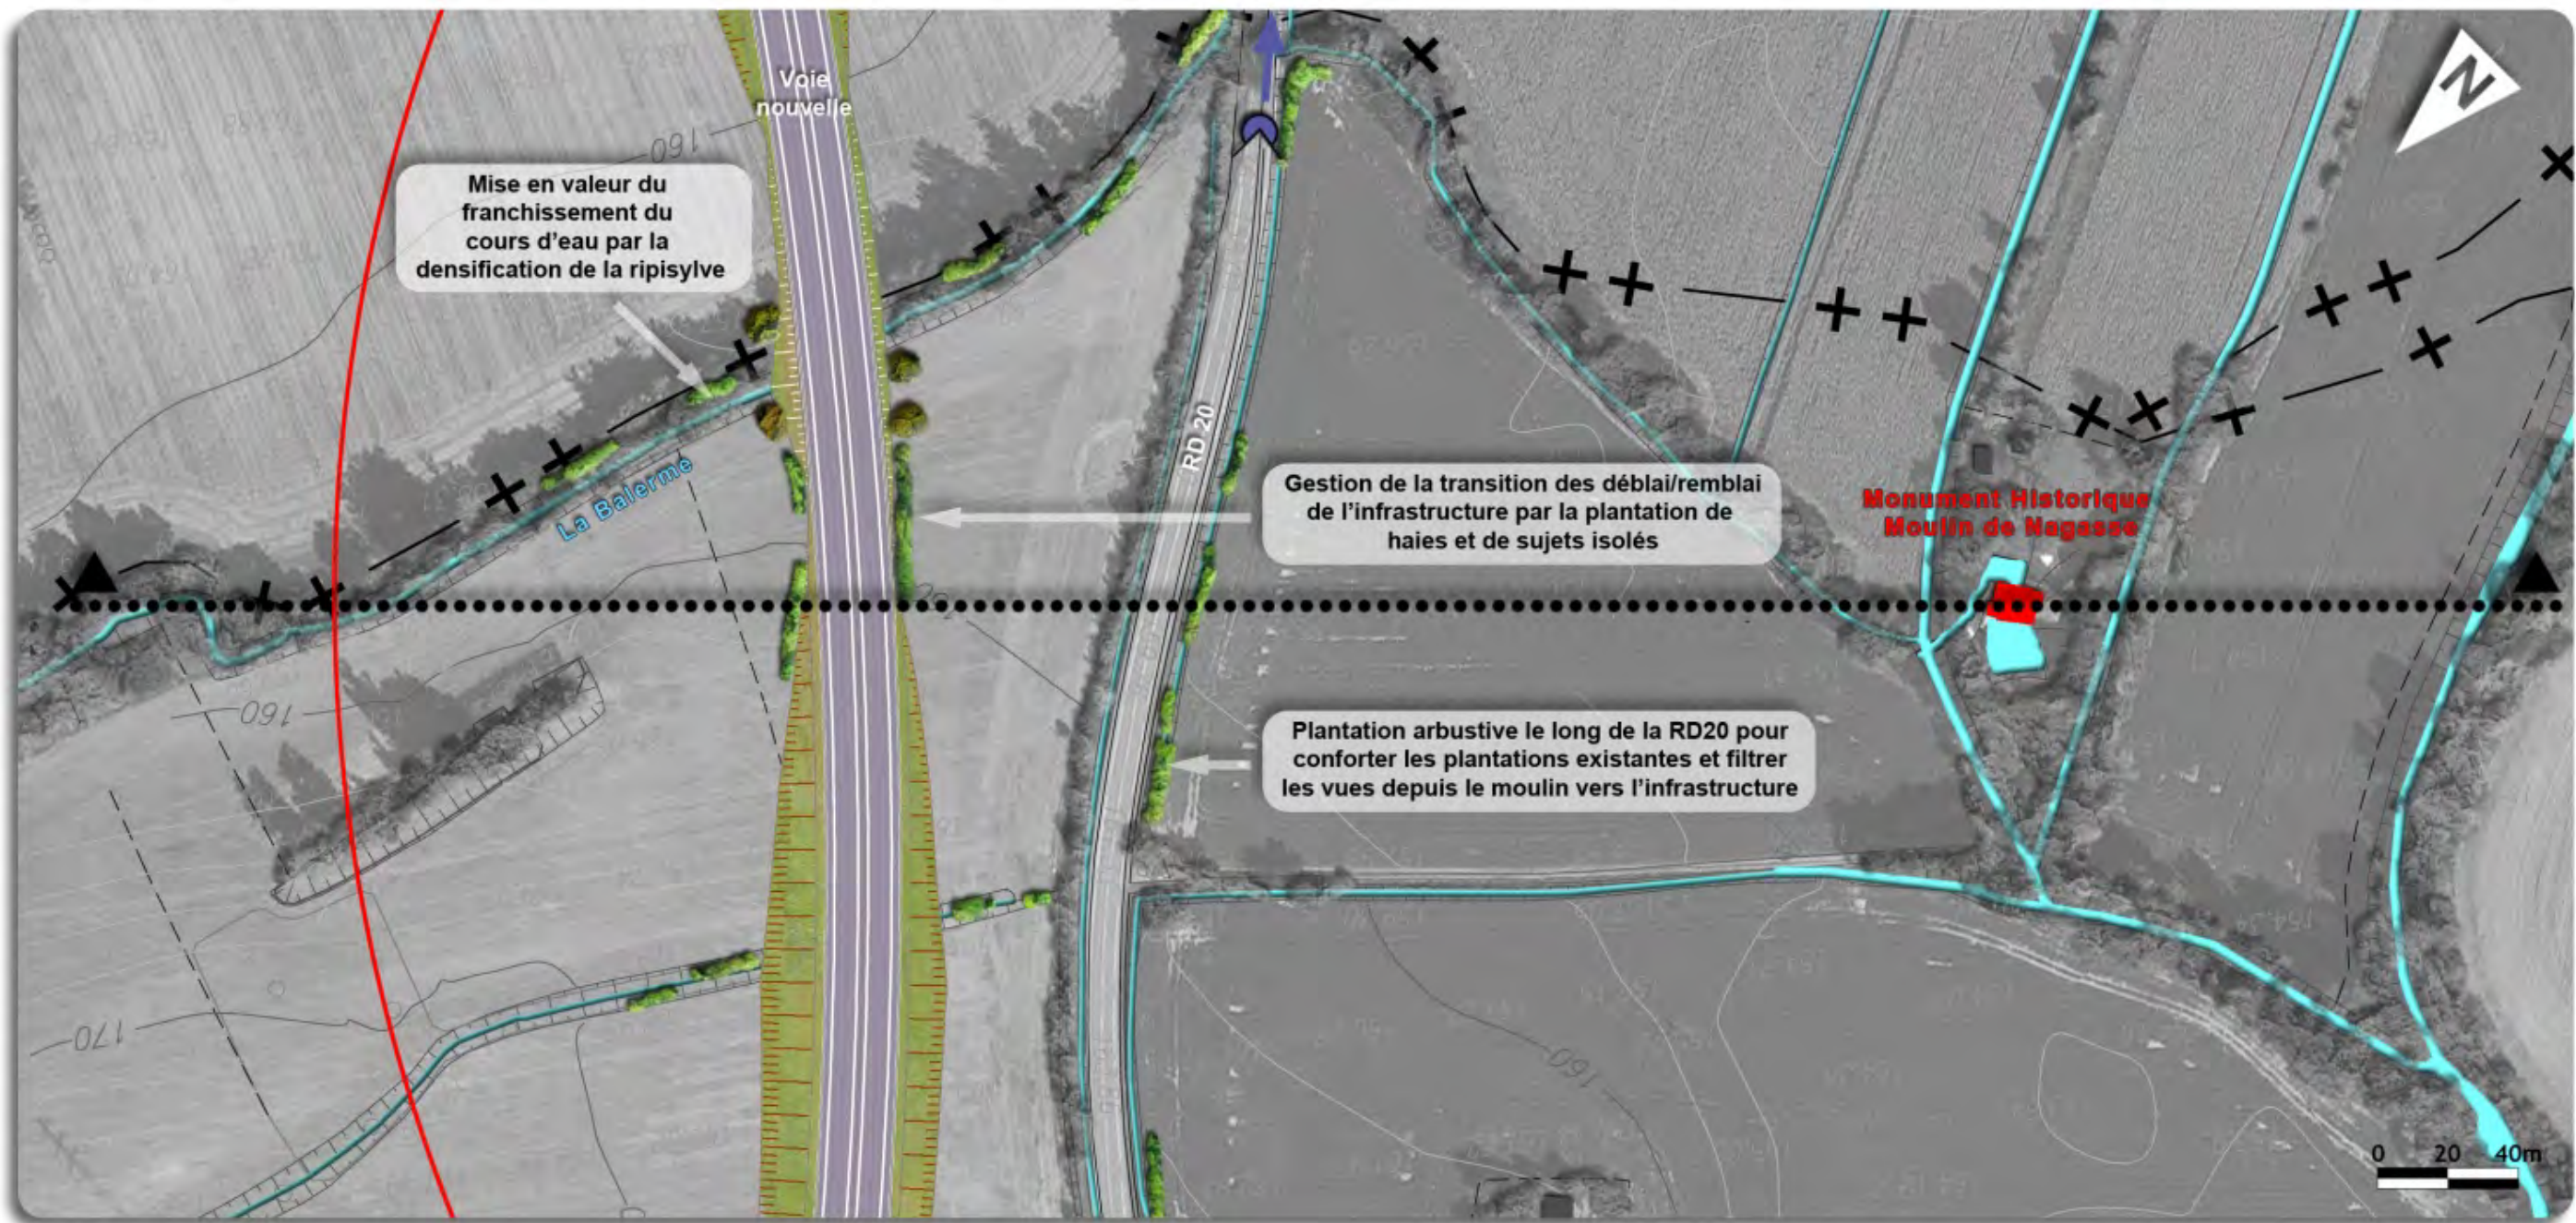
Croquis sur le secteur du Moulin de Nagasse (plan masse précédent)
